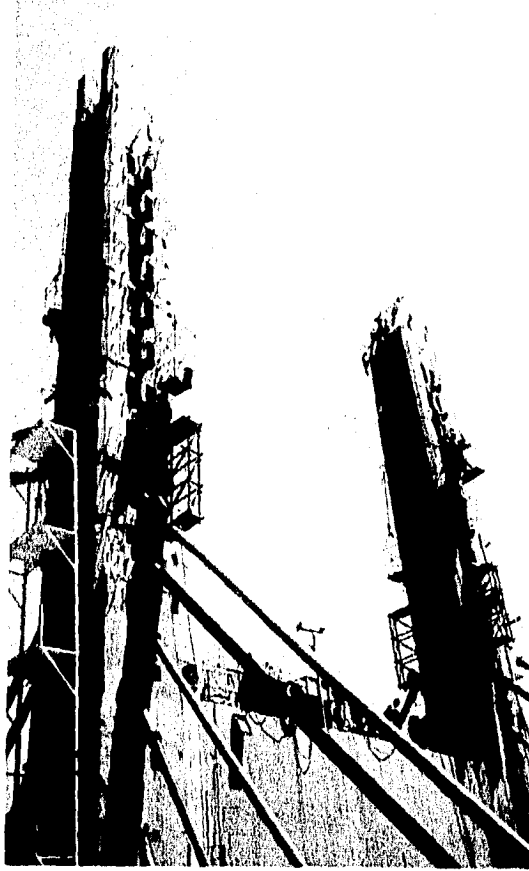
Vista general de los pilones y tubos cañón.
